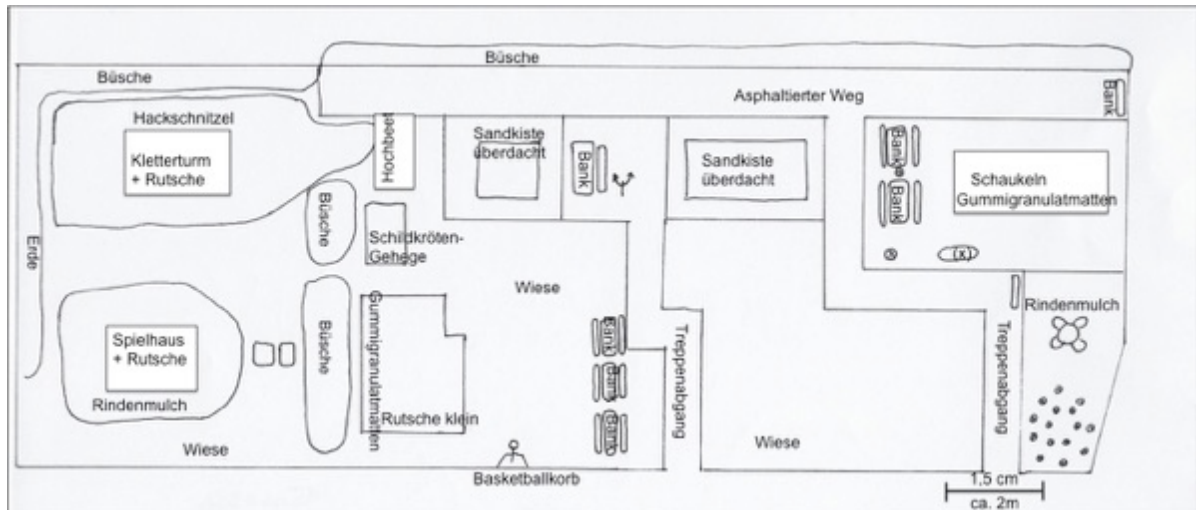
Lageplan KG E. Die Anordnung der einzelnen Elemente wird durch den Plan veranschaulicht (Purin, 2016).
